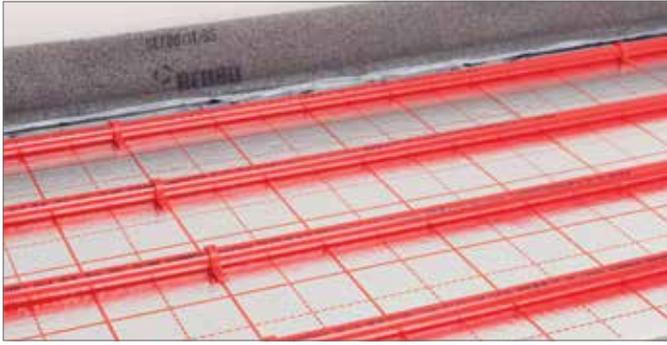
Sistema di fissaggio tubi RAUTAC 10
